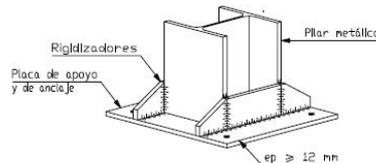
Placa de anclaje-pilar con rigidizadores
